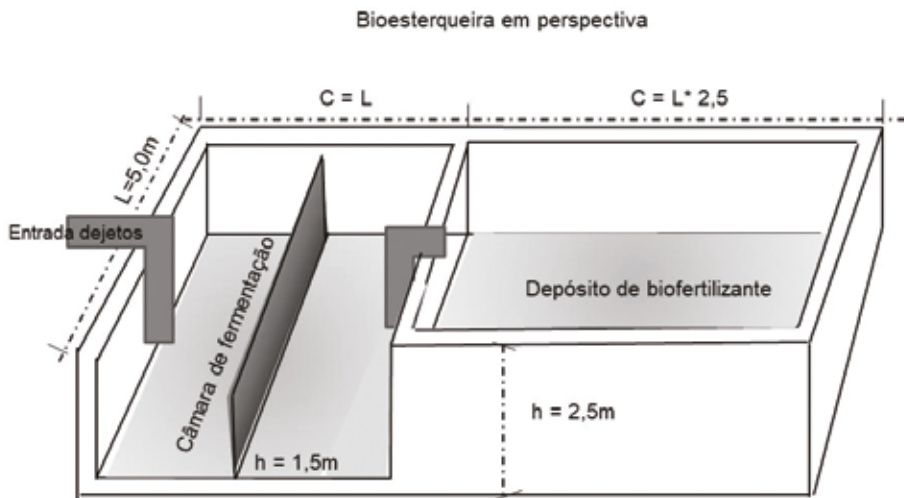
Vista tridimensional de uma bioesterqueira construída em alvenaria
